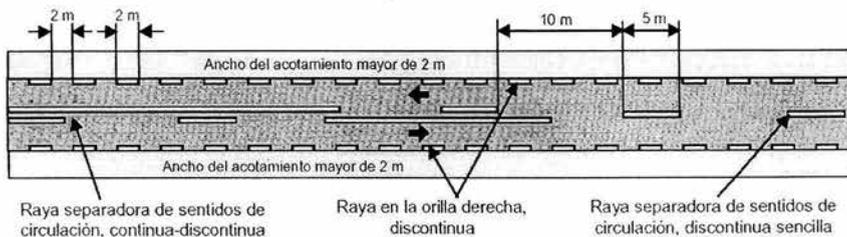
Marcas en el pavimento en carreteras con ancho de calzada mayor de 6,5 m
